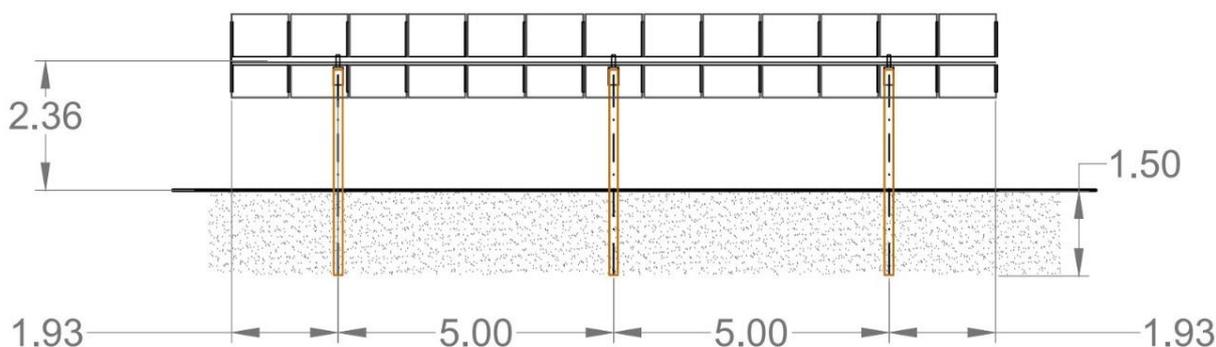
Stralcio prospetto struttura di supporto 2x13
